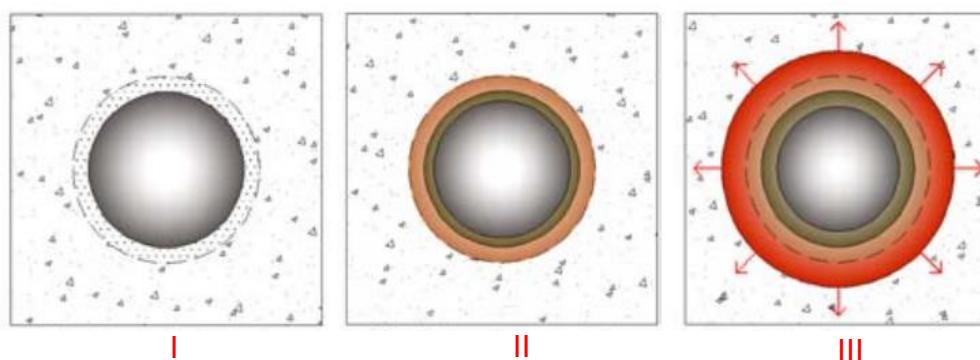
Processo de fissuração do concreto (adaptado de LORENSINI, 2006).
